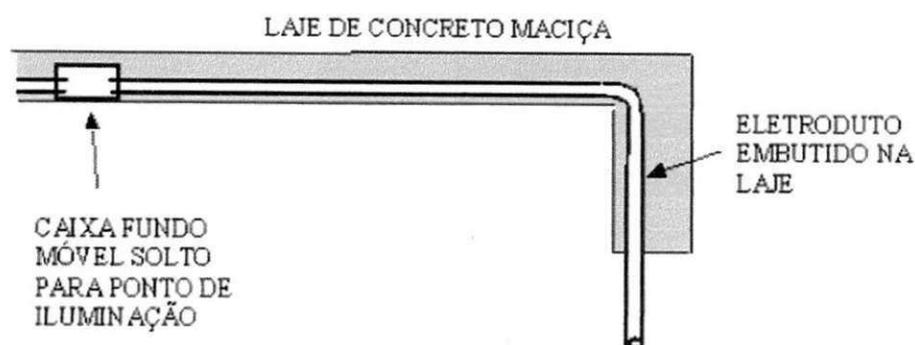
Eletroduto percorre trechos horizontais embutido na laje de concreto e desce trechos verticais na parede
